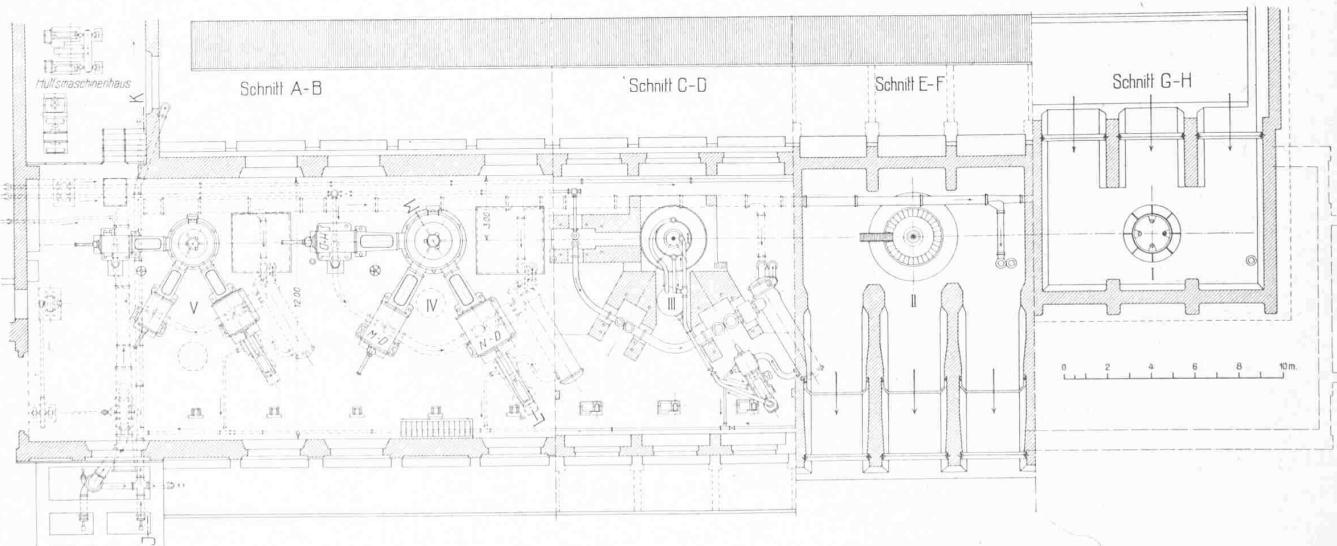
Grundriss und Horizontalschnitte des neuen Maschinenhauses der Pumpenanlage in Codigoro. — Masstab 1:300.
